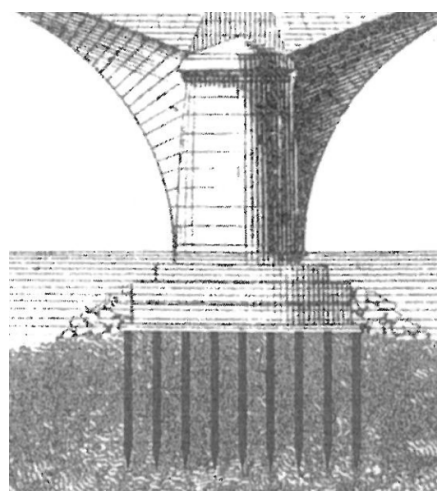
Fondation d'une pile du pont de Neuilly (Maillard, 2006)
